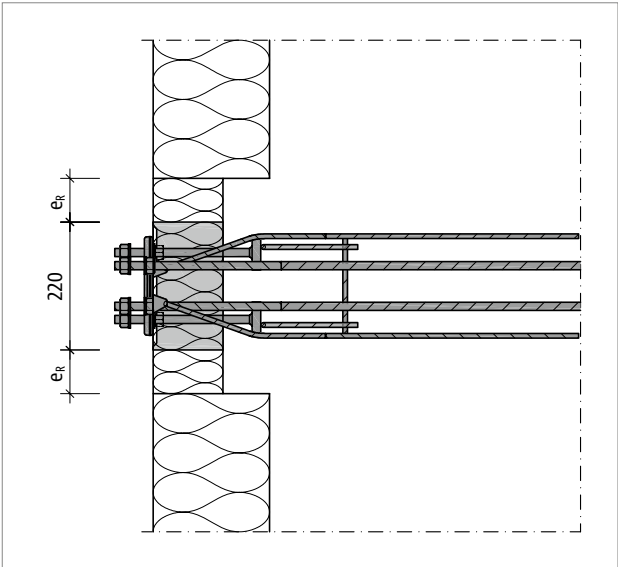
Schöck Isokorb® XT Typ SK: Randabstände
